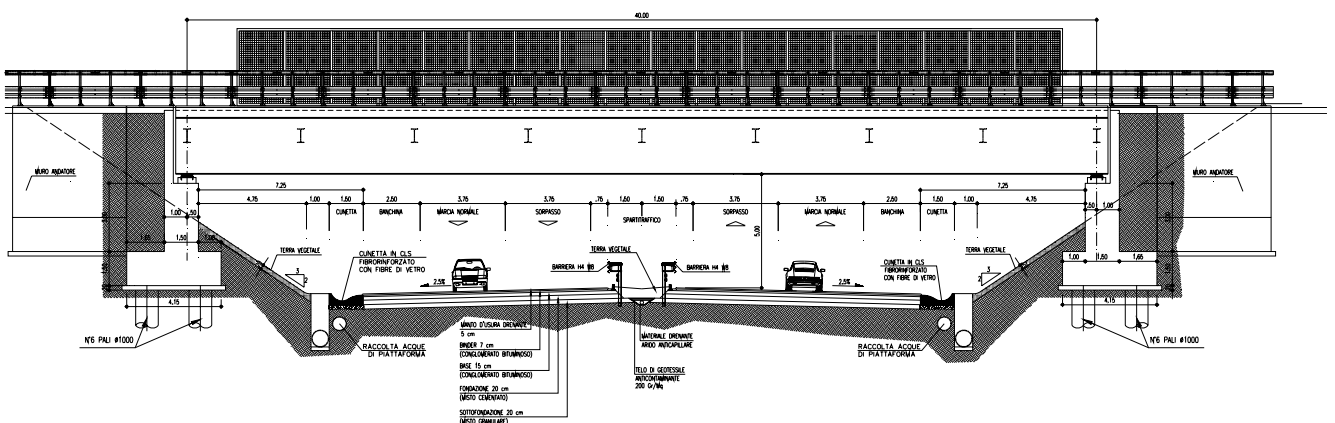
Profilo longitudinale tipo di cavalcavia in acc. Cls.
